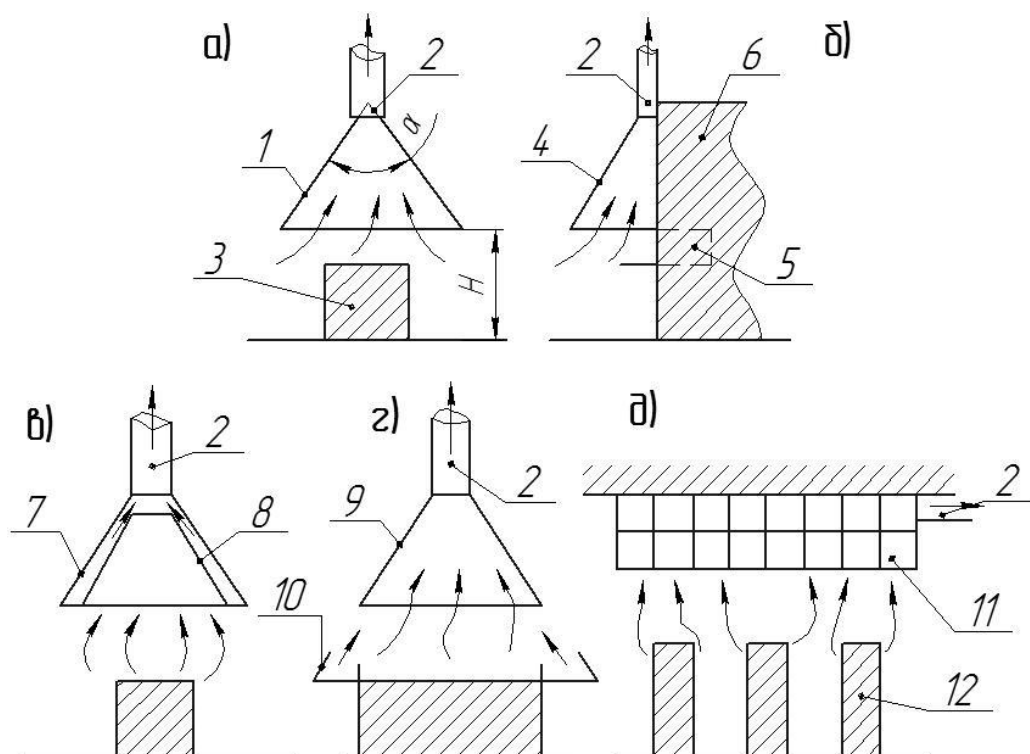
Конструктивні схеми встановлення витяжних ковпаків
